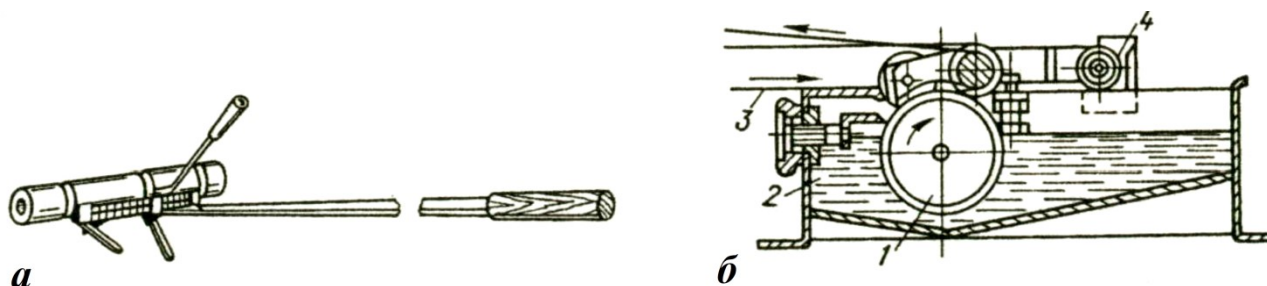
Пристрої для нанесення клею на шпалери: а - ручний валик; б - спеціальний пристрій: 1 - барабан; 2 ванночка з клеєм; 3 - шпалерна стрічка; 4 - протягувальний вал
